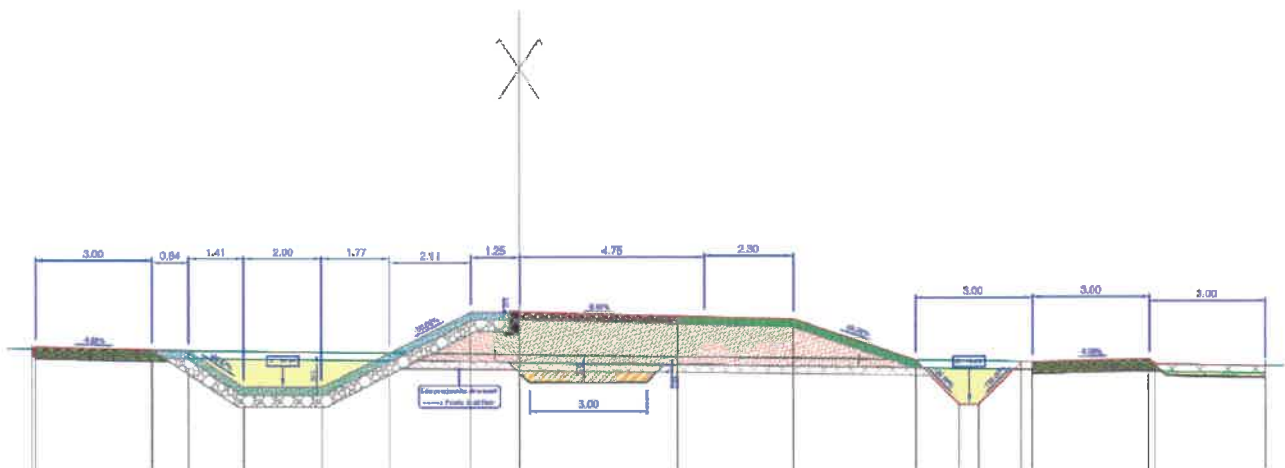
Exemple de coupe d'une digue « neuve » de Sallèles-d'Aude (source : Plan Exe)
